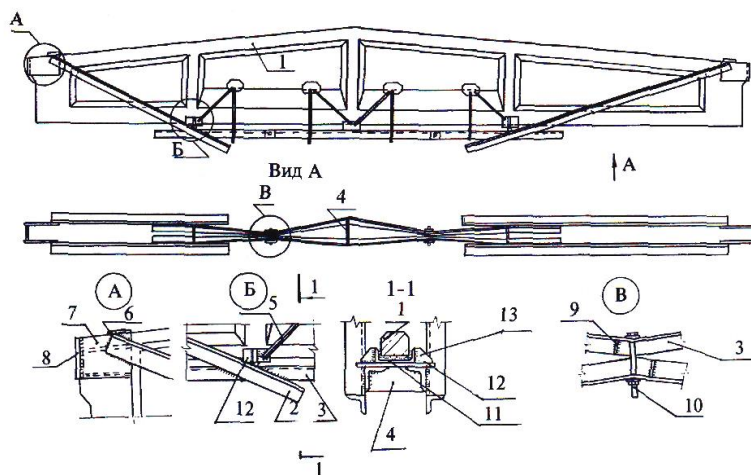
Усиление сборной железобетонной стропильной балки устройством жесткого предварительно напряженного шпренгеля:
